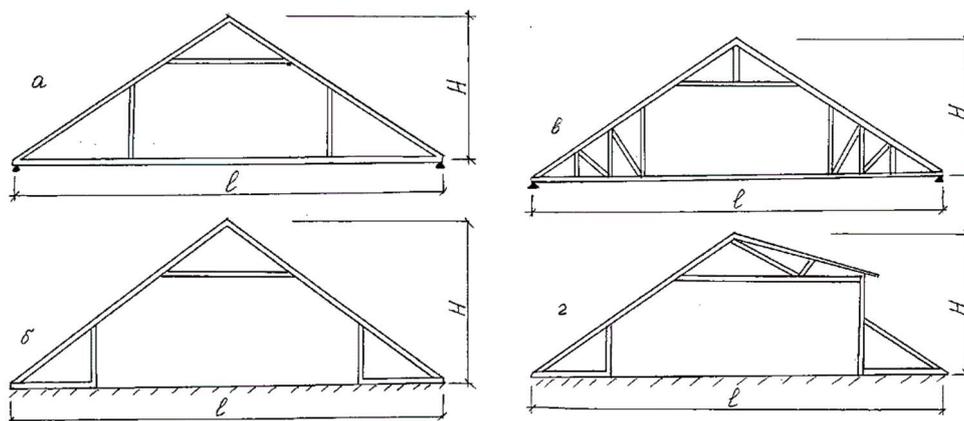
Основные типы мансард с применением металлических зубчатых пластин:
